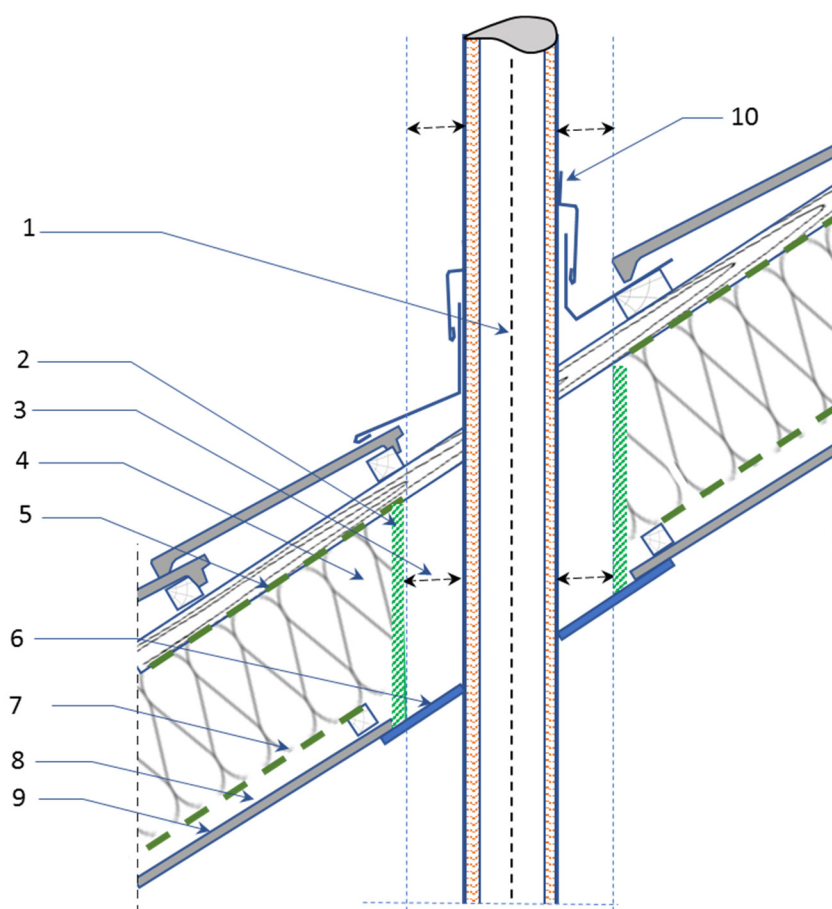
Coupe verticale : Traversée d'une paroi inclinée (rampant) de comble : conduit de fumée métallique double paroi avec système de kit isolé sous Avis Technique
